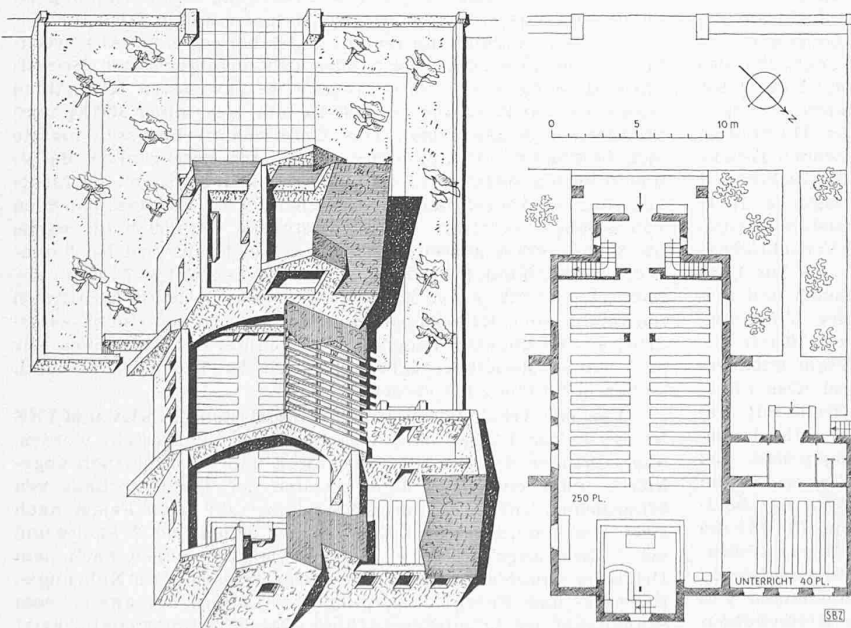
Isometrischer Schnitt und Abb. 22 Grundriss 1:400 der Reformierten Kirche der Dörfer Mathod und Suscévaz. Arch. PAUL LAVENEX, Lausanne
